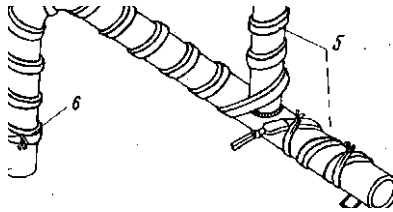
Схема монтажа гибких нагревателей ЭНГЛ-180 на оборудовании сложной формы.
